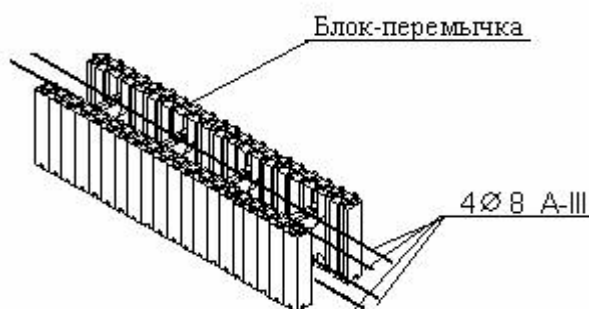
Установка арматурных стержней в блоки перемычки
